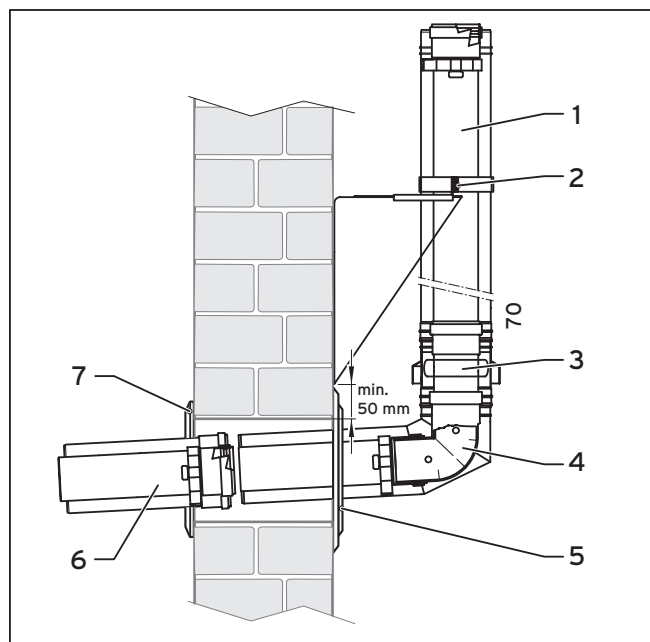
Монтаж подключения для прокладки по наружной стене
